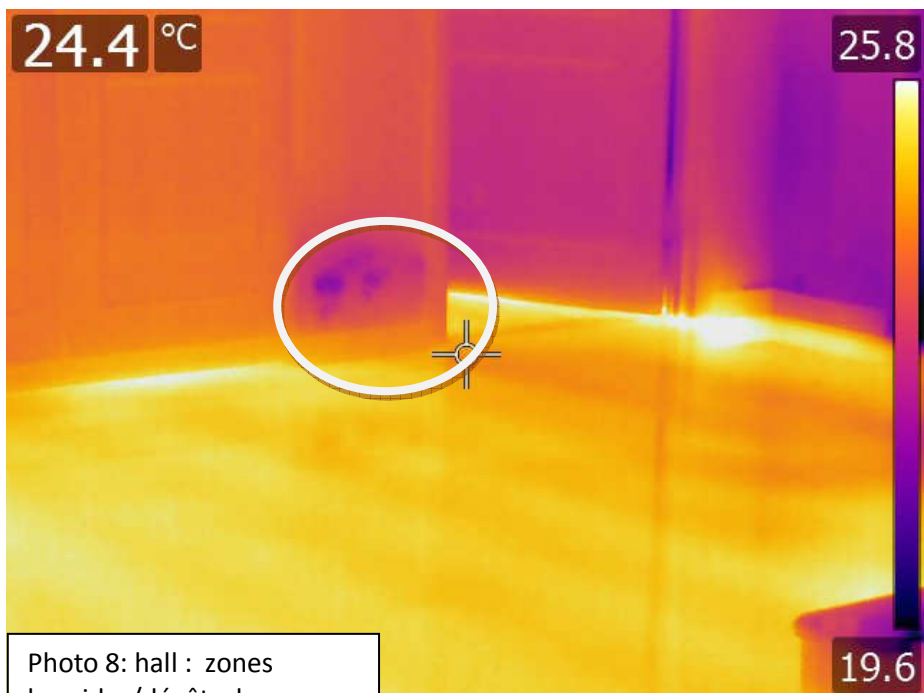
hall : zones humides/dégâts des eaux sur le mur côté bureau
